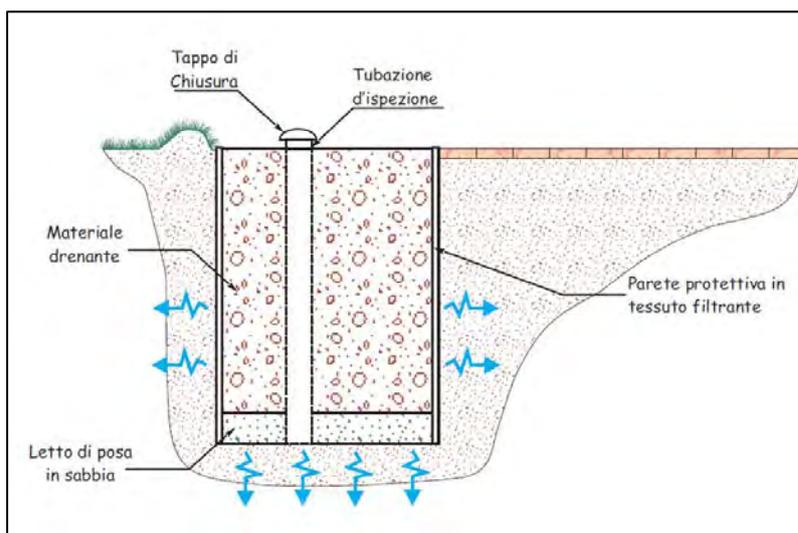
Sezione di trincea drenante– Drenaggio Urbano (Muraca, Mangone, 2006 modificato)
